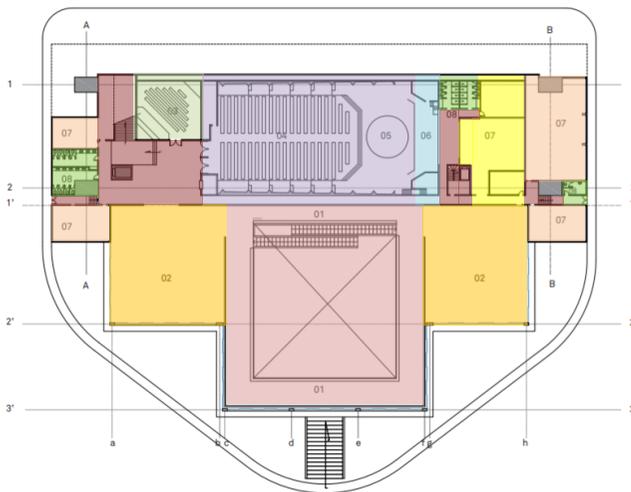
Planta baixa do nível -4.50. Fonte: Archdaily A, 2019.
